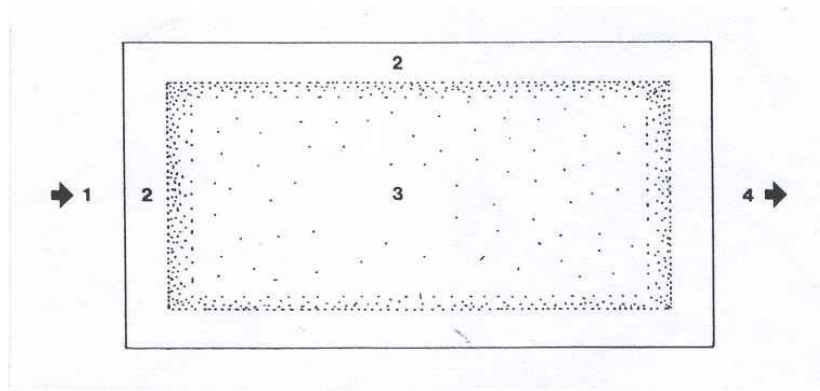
Disposición de los elementos de un estanque de infiltración. 1.- Alimentación, 2.- Bordes o muros laterales, 3.- Fondo permeable, 4.- Rebase.
